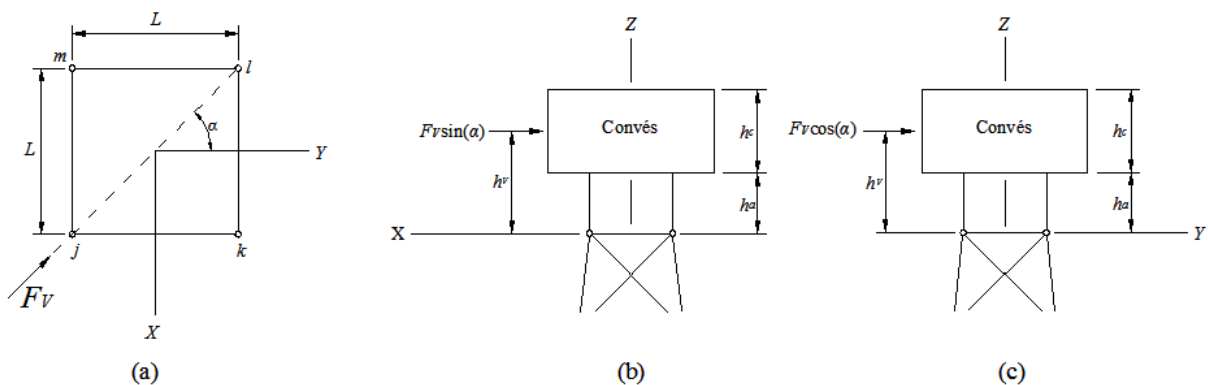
(a) Vista em planta dos nós do topo da plataforma; (b) e (c) vista em elevação nos planos XZ e YZ , respectivamente.
